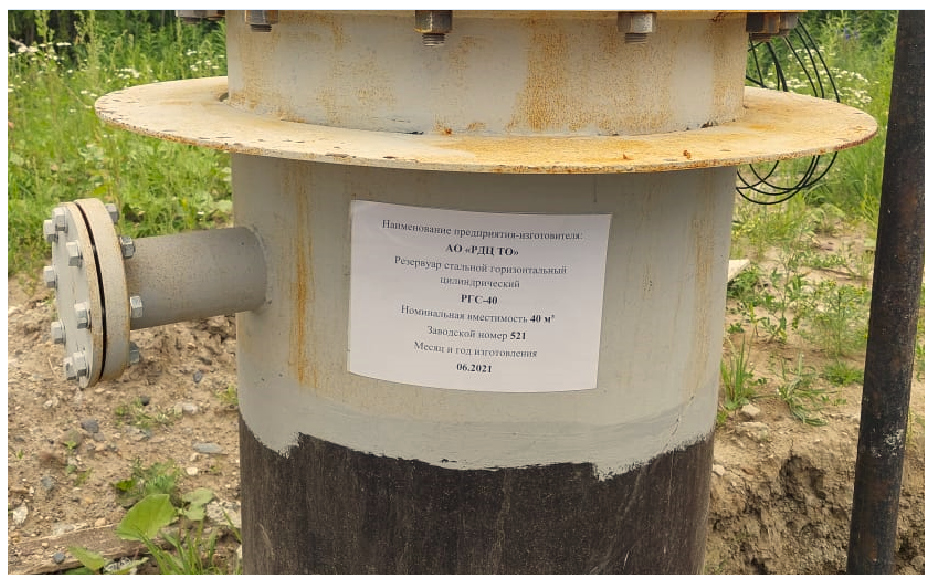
Маркировочная табличка резервуара РГС-40
